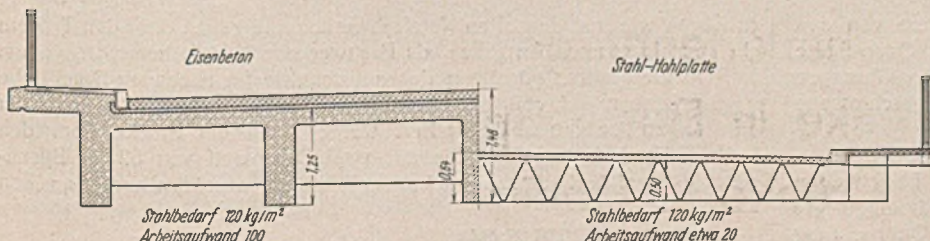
Vergleich zwischen einer Eisenbetonbrücke und einer Stahlhohlplatte für eine Straßenbrücke.
